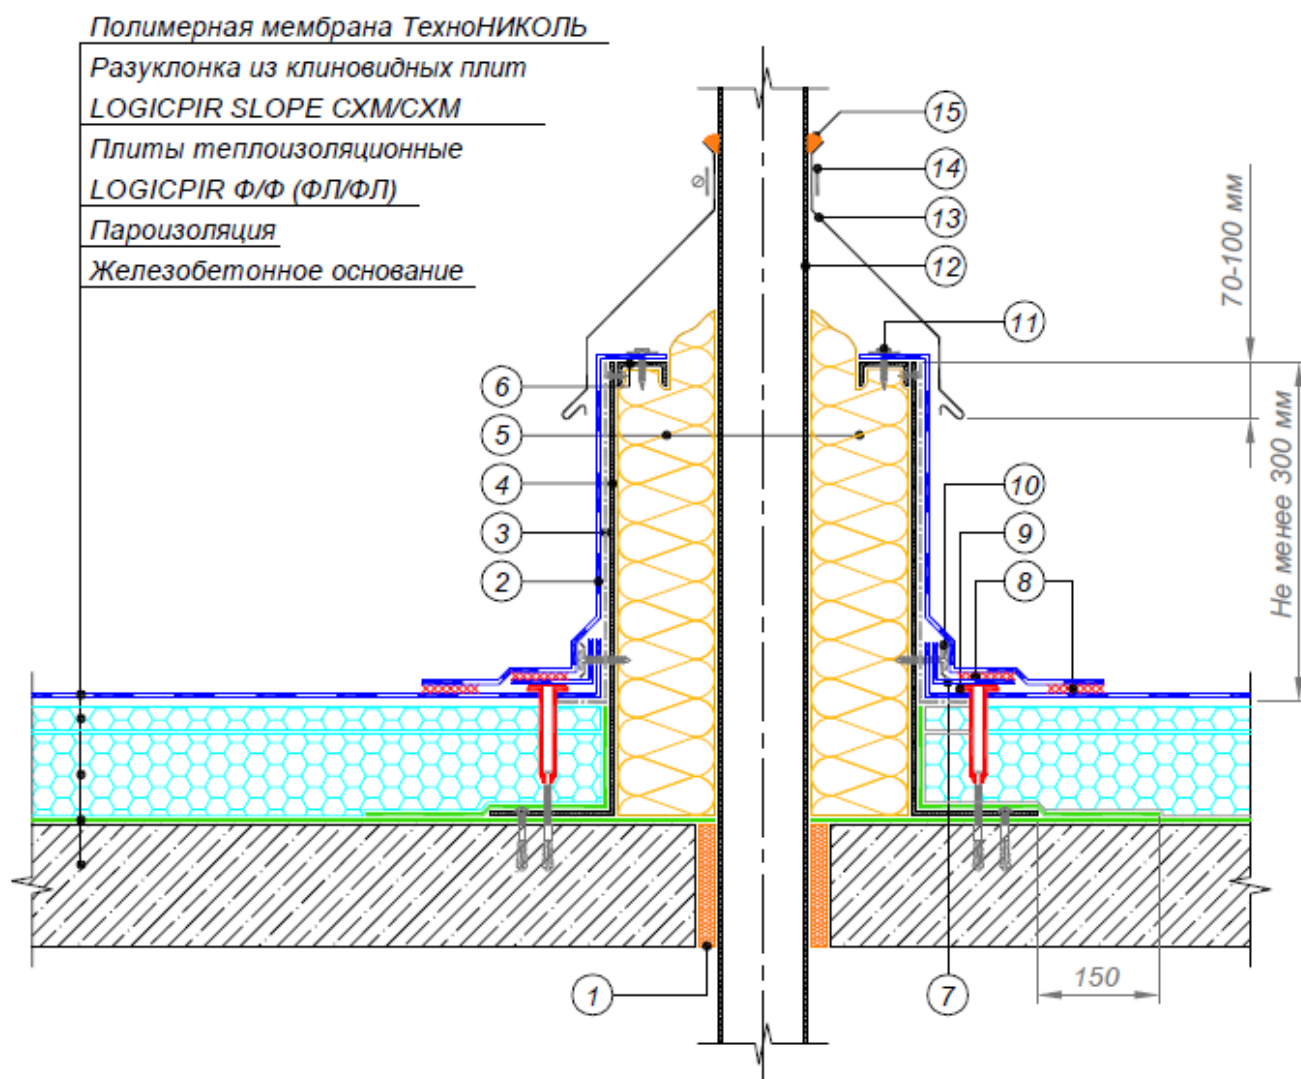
Примыкание кровельного ковра к горячей трубе
